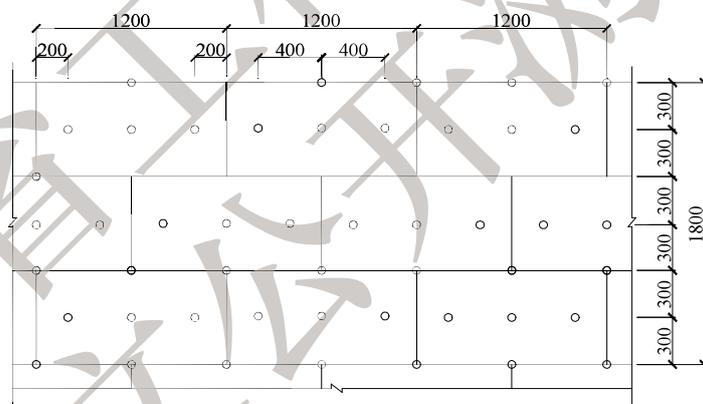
硬泡聚氨酯板锚栓布置示意 (尺寸单位: mm)
